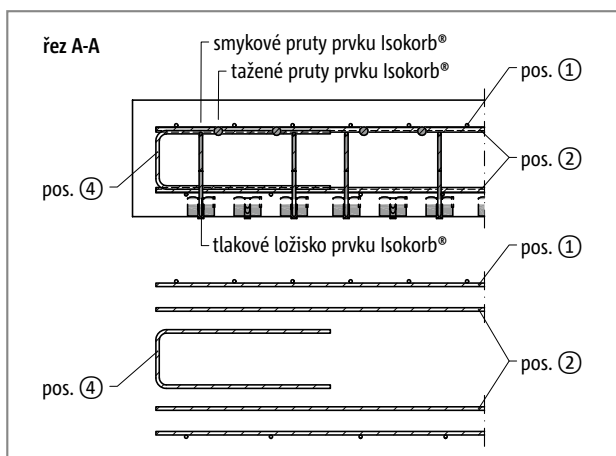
Schöck Isokorb® CXT typ KL: Napojovací stavební výtuž u přímého uložení
